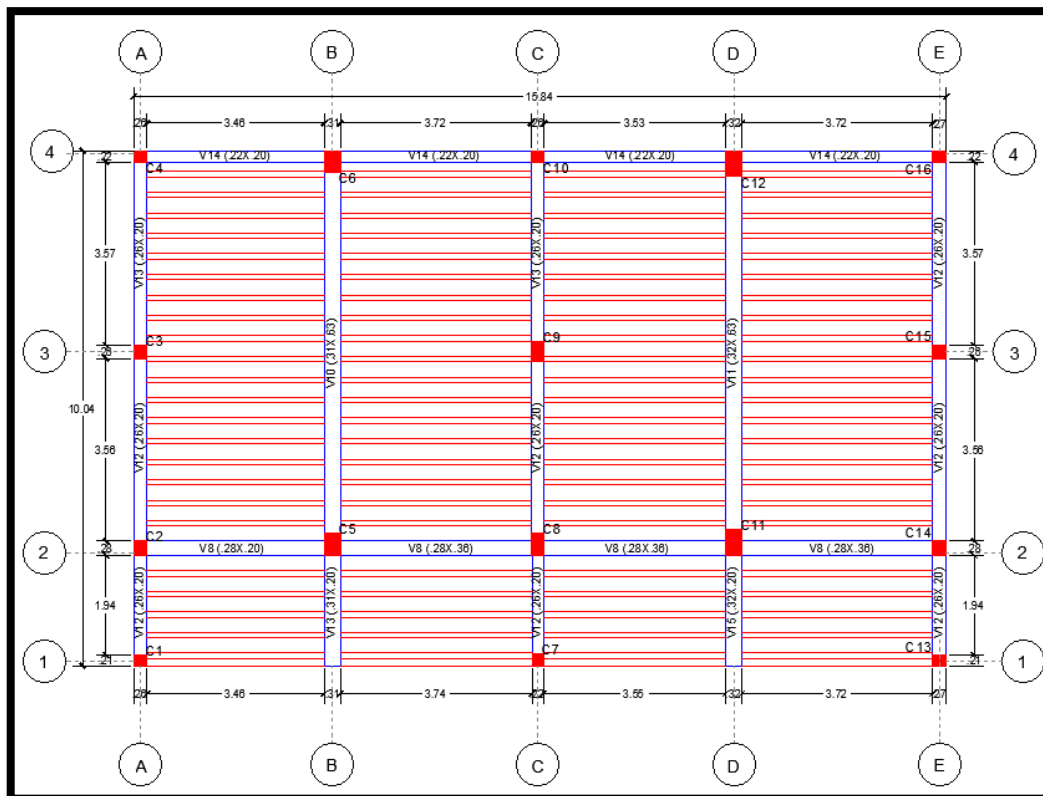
Plano de detalle de acero en losa aligerada – segundo nivel
